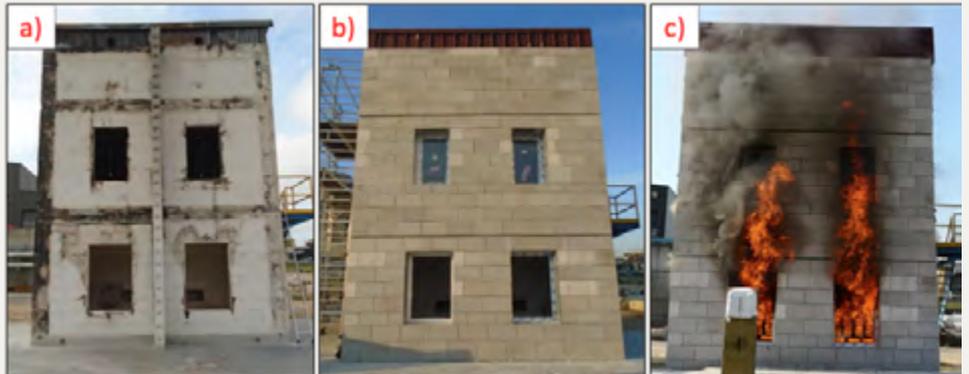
a) Façade brute recevant le support béton (épaisseur 16 cm) ; b) Maquette finalisée avant essai (5,65 m de longueur pour une hauteur de 7,20 m) ; c) Maquette soumise au feu après 15 min d'essai - photos CTMNC
